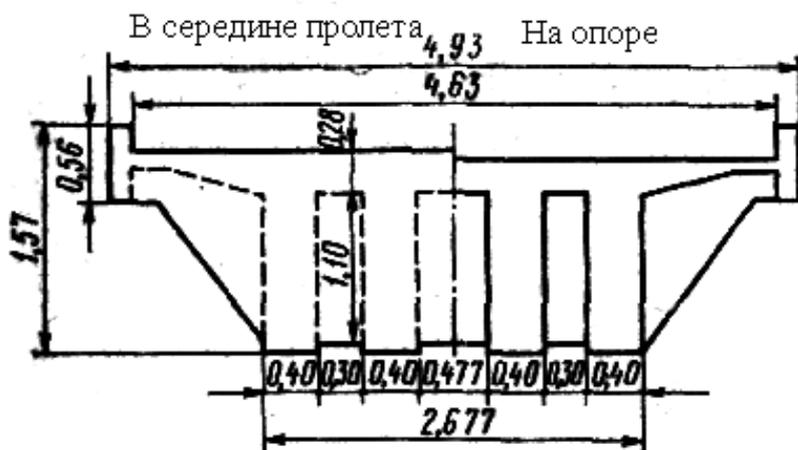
Поперечное сечение железобетонного пролетного строения расчетным пролетом 10,06 м под нагрузку 1907 г
